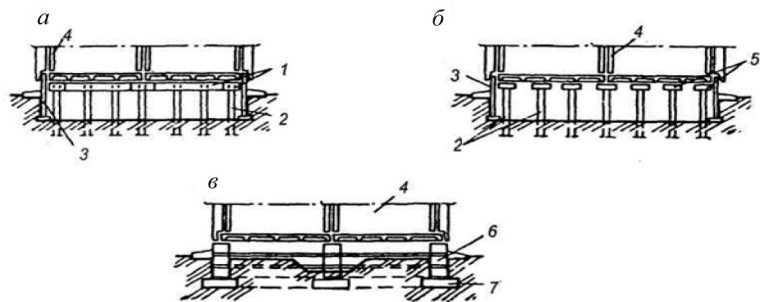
Фундаменти об'ємно-блокових будівель:
